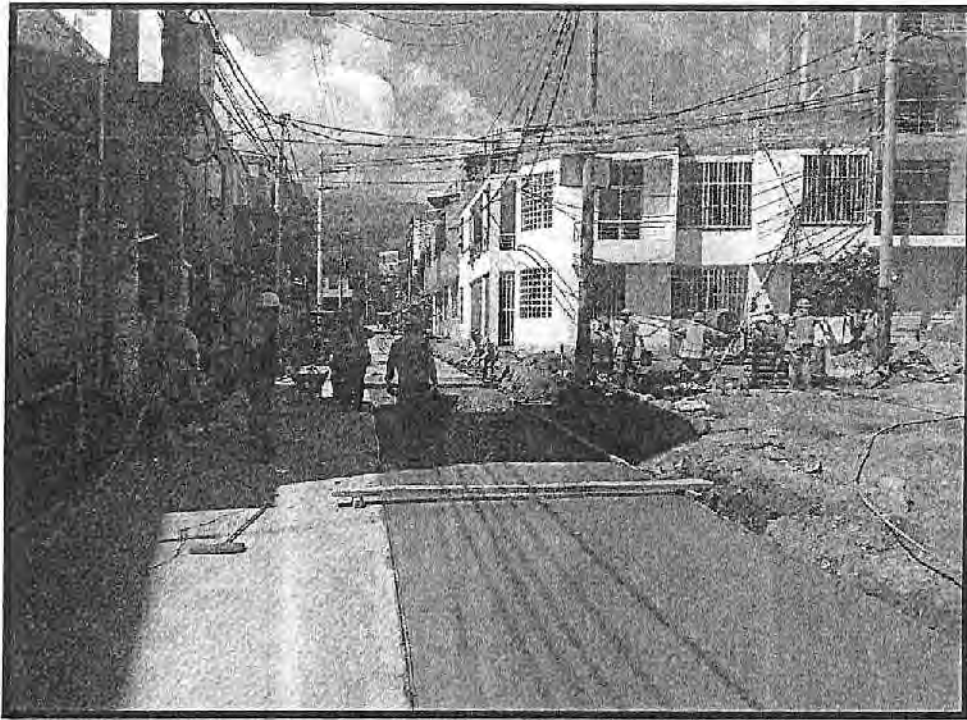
CONCRETO DE LOS MACISA F'C=210 kg/cm².
